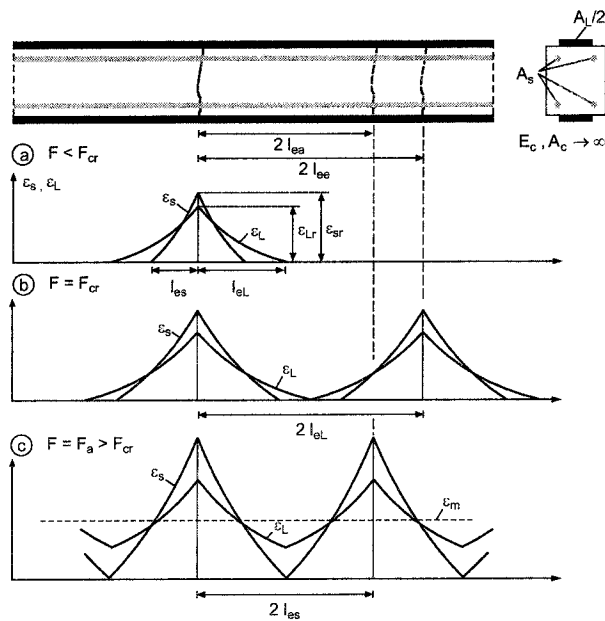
Rissbildungsstadien eines verstärkten Stahlbeton-Zugstabes (schematisch)
